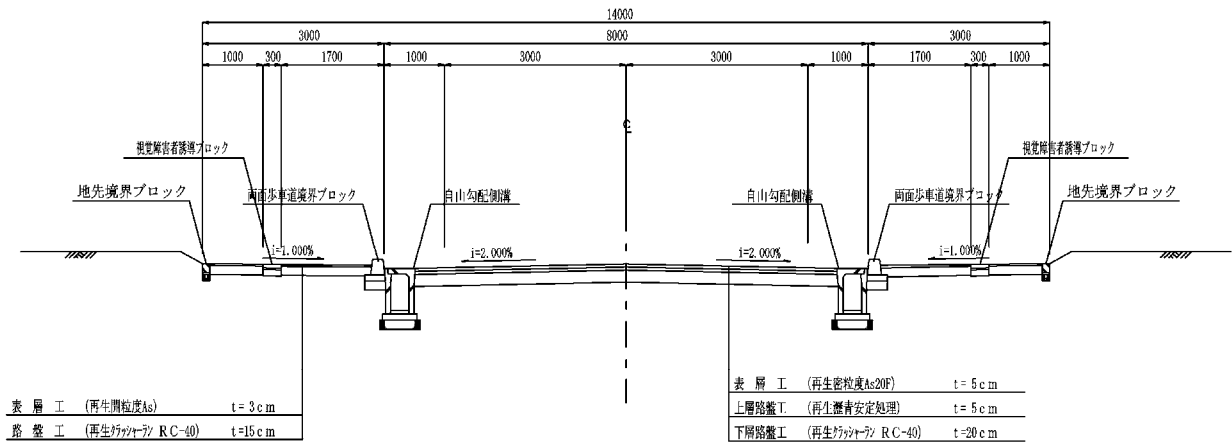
(2) 道路標準断面図(補助幹線道路:14m)
